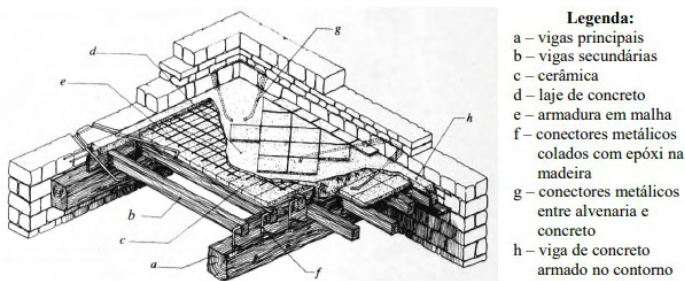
Aplicação de estrutura mista em concreto/madeira
